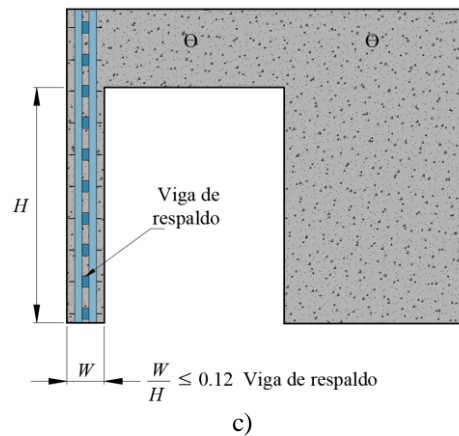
Representación de pilastras externas de acero requeridas durante el izaje
